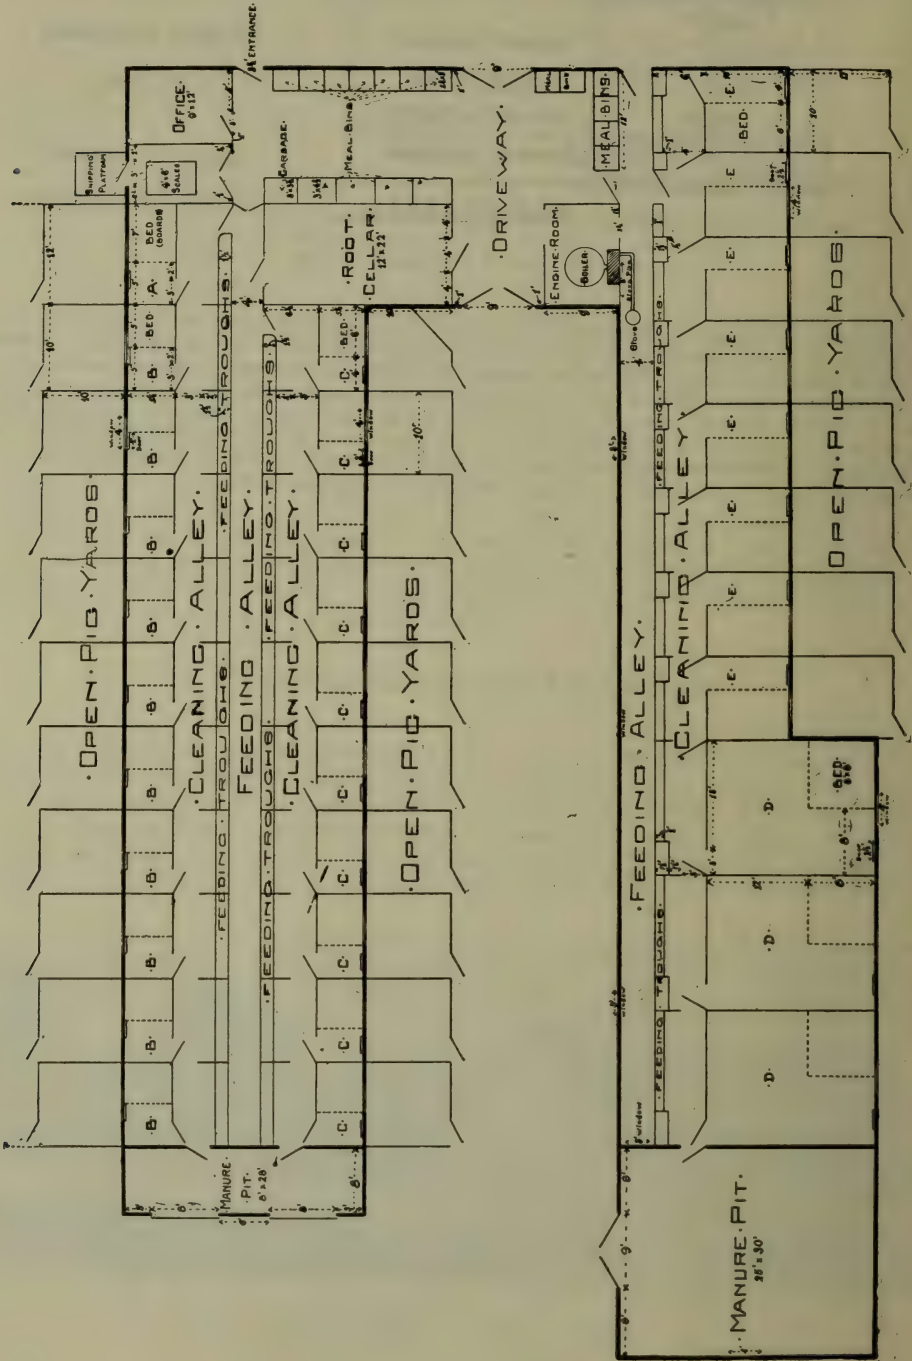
Plan du plancher de la porcherie du collège Macdonald
